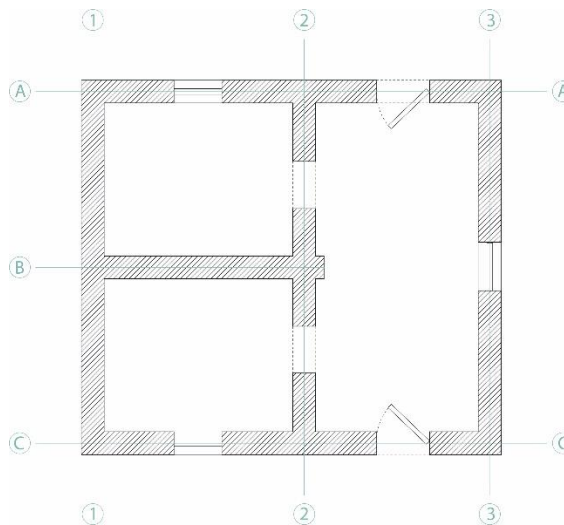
Elaboración propia. Plano de planta vivienda de tres ambientes.
